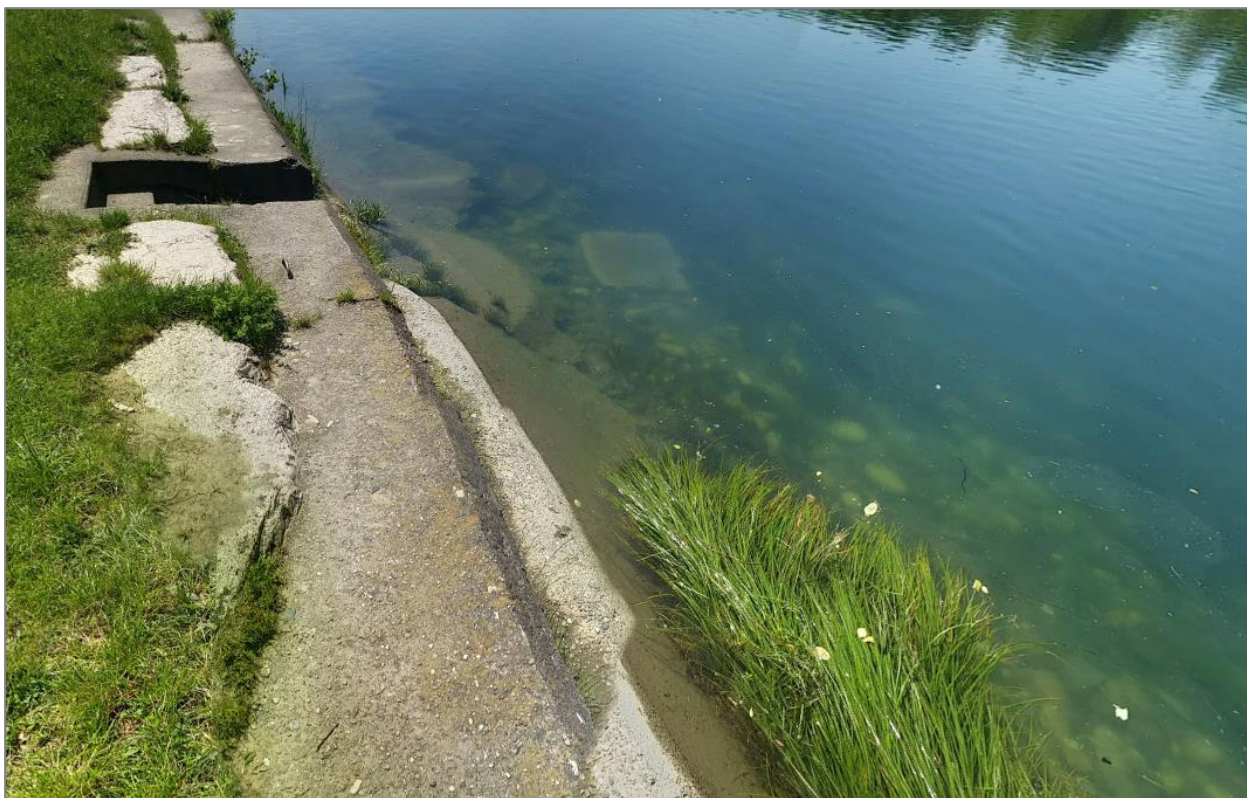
Sito di installazione proposto per la stazione Oleggio, vista da monte
